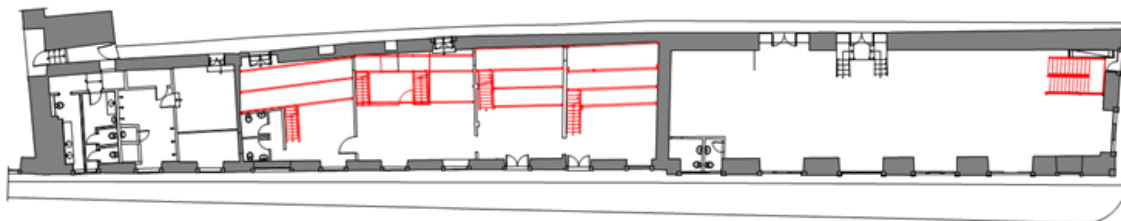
Planta baixa do pavimento térreo dos Blocos 02 e 03
